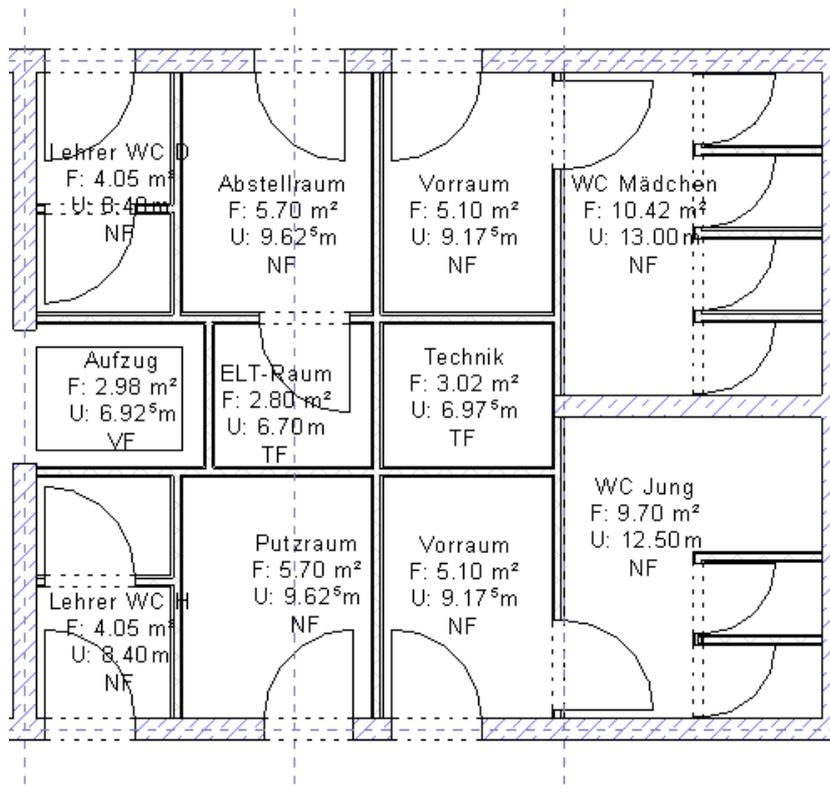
Grundrissausschnitt mit Raumstempel
